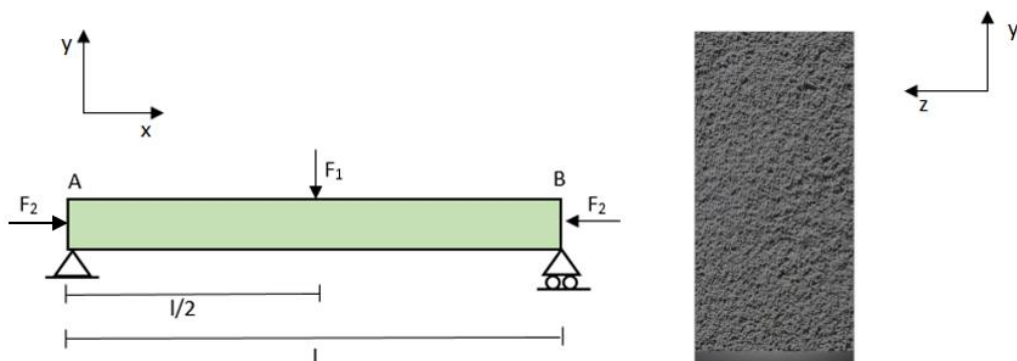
Viga de hormigón con refuerzo de acero sometida a flexión compuesta recta, sección transversal y condiciones de contorno.
